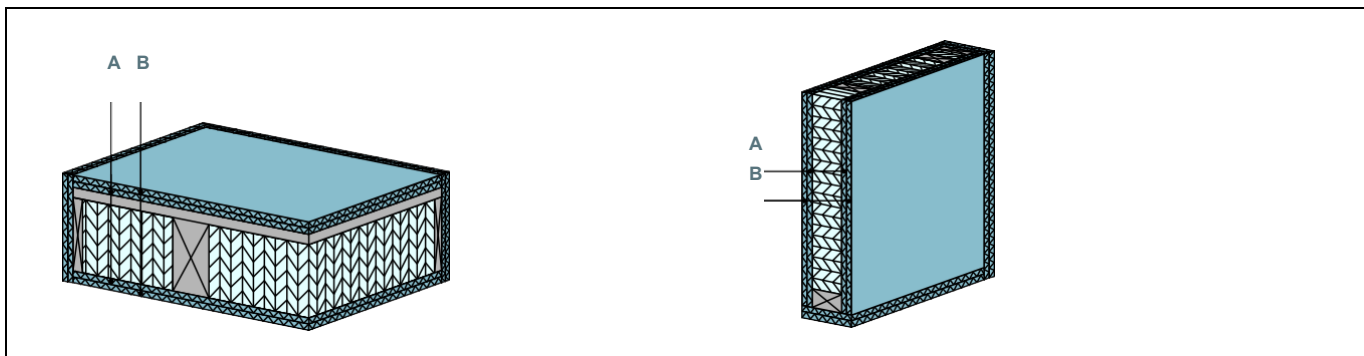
Définition des couches d'un revêtement multicouche K tt-RF1
